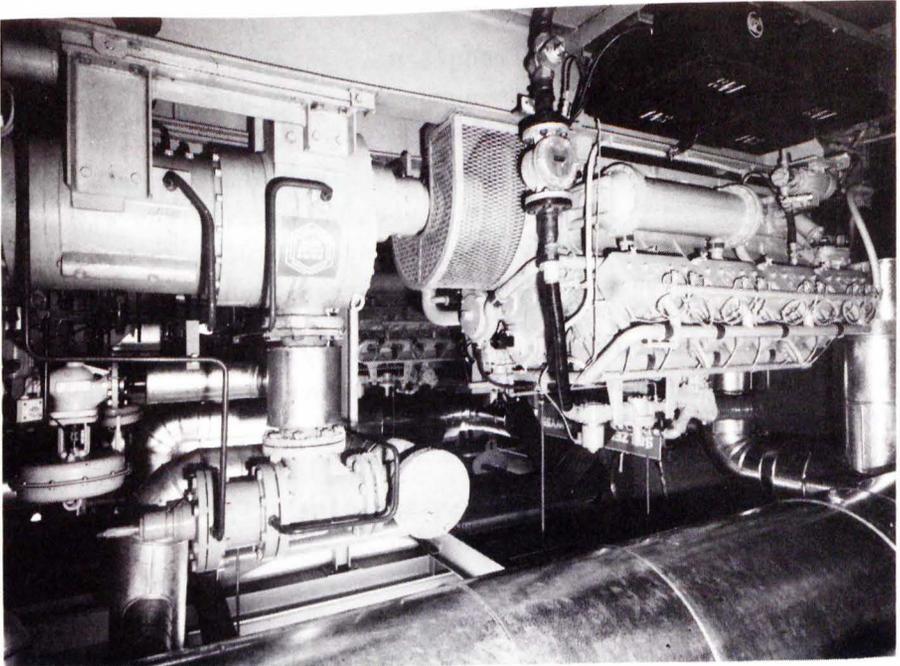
Schraubenverdichter mit Gasmotor in einer Molkerei
